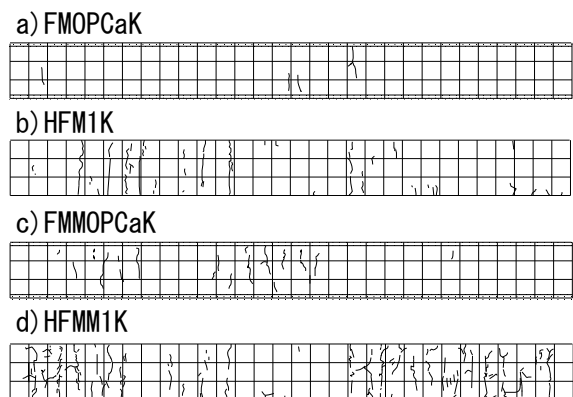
梁部材の乾燥収縮ひび割れ(打設面)
